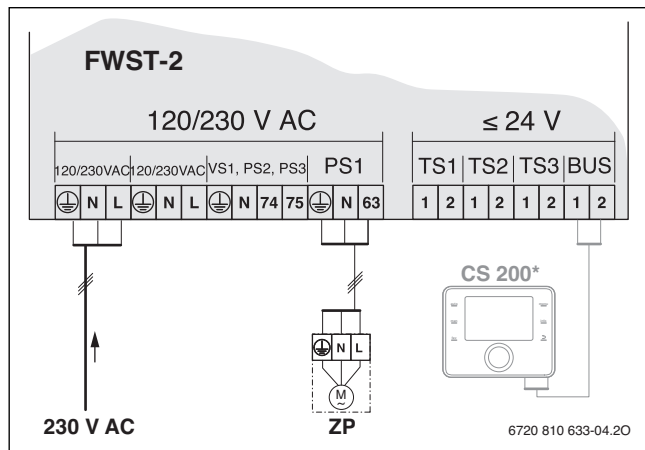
Anschlussplan CU FWST-2 (Legende → Bild 1)
